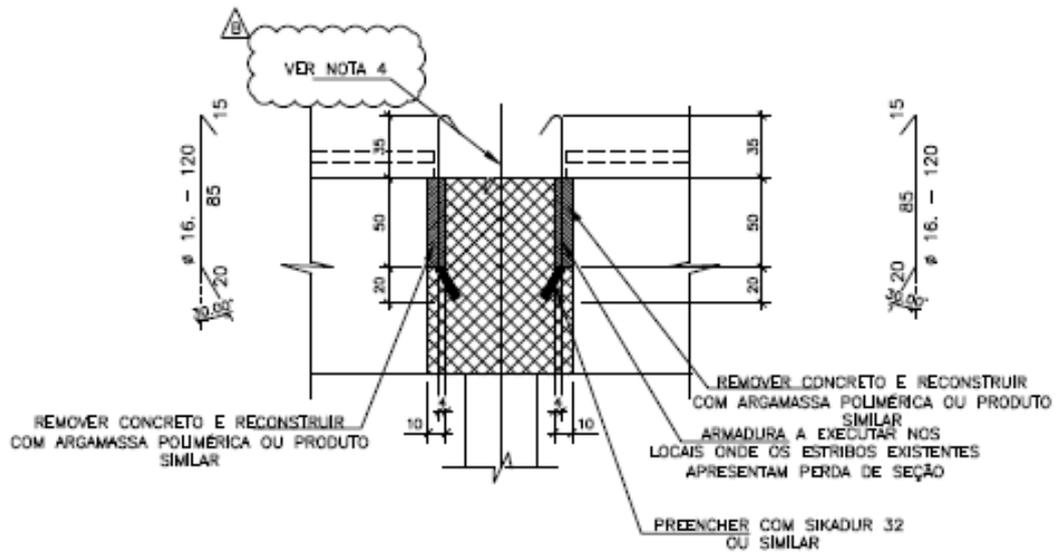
Detalhe da recuperação estrutural das vigas internas
